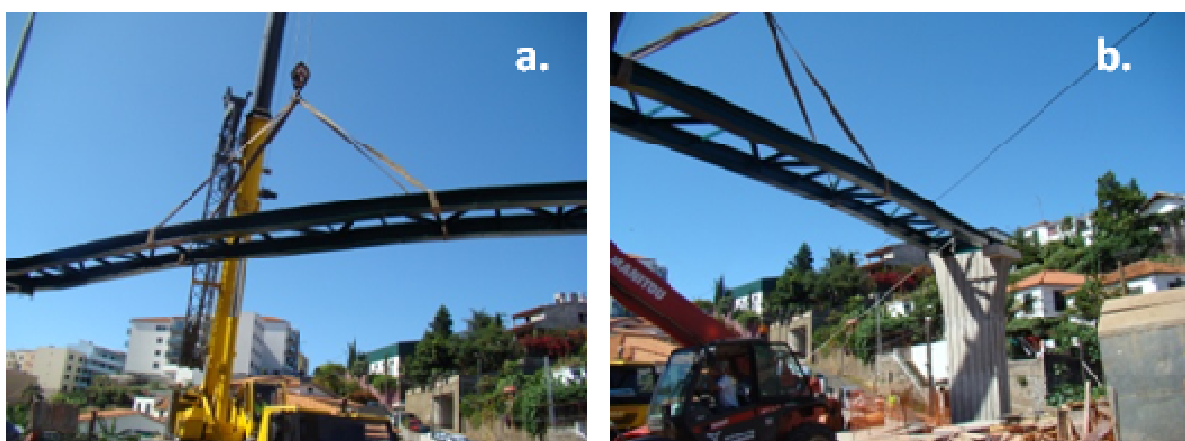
Acerto da estrutura metálica principal sobre os pilares
